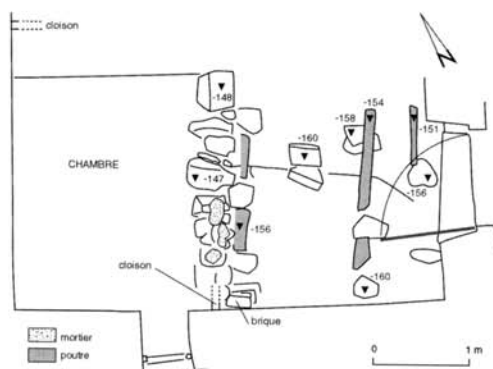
Plan partiel de la «cuisine» avec fondation de la cloison de la chambre, supports et poutres du plancher. Dessin JT. DAO Frédérique Gillet.
